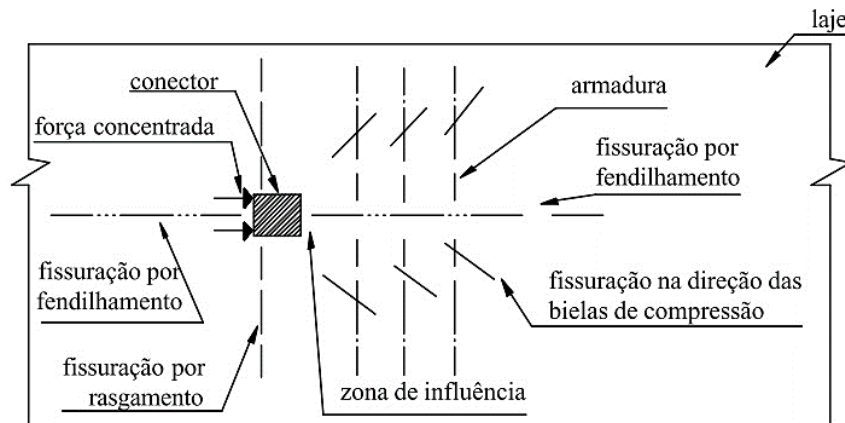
Tipos de fissuração na laje devido à concentração de tensões gerada pelo conector (OEHLERS, 1980; TRISTÃO, 2002)
